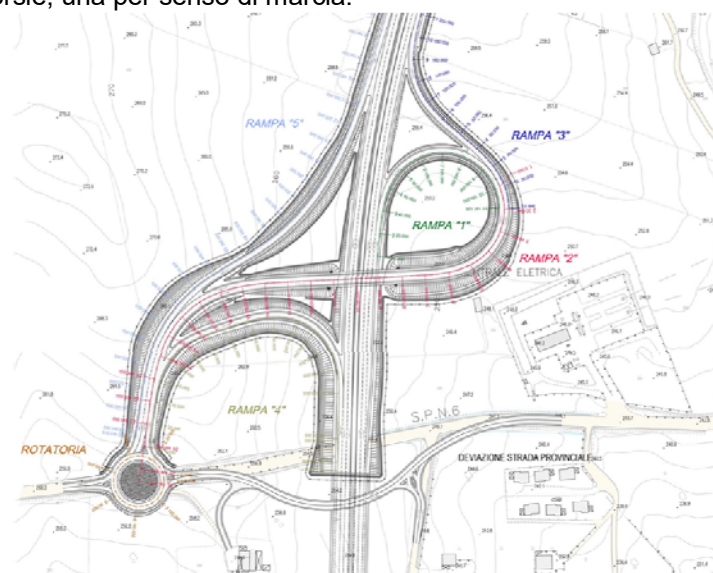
Planimetria Svincolo "Matera Ovest"
